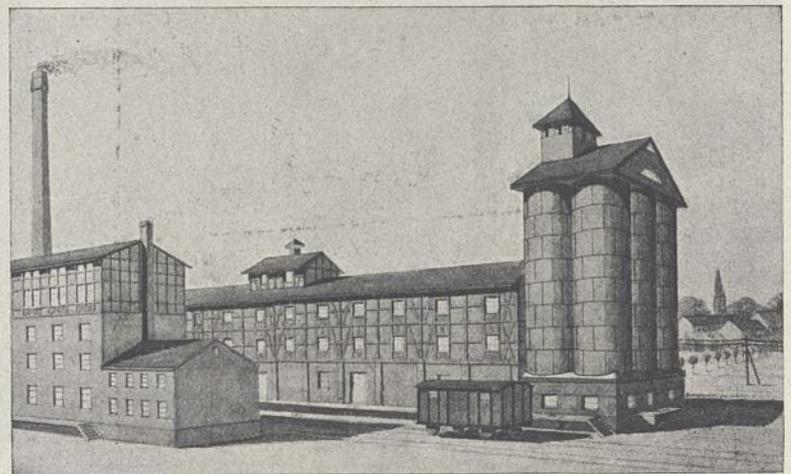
Dampf- und Wassermühlenwerk Isenschnibbe bei Gardelegen.
